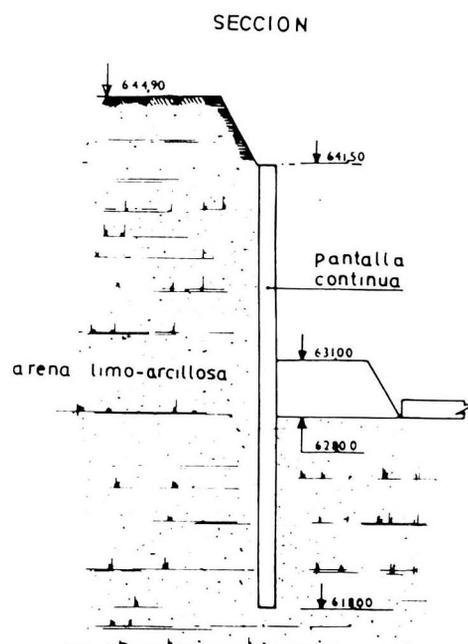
EXCAVACION MEDIANTE BANQUETA PERIMETRAL
